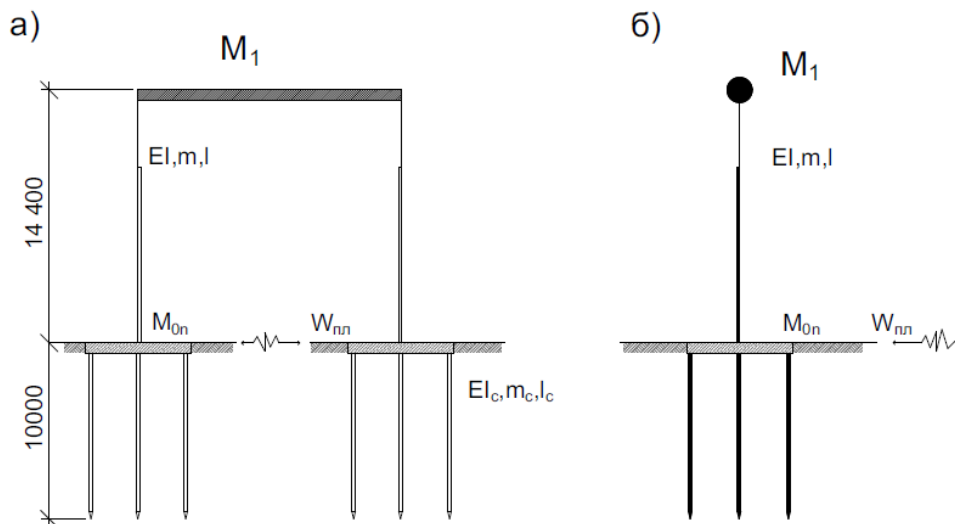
Схема плоской рамы на свайном фундаменте: а – схема рамы; б - динамическая расчетная модель
